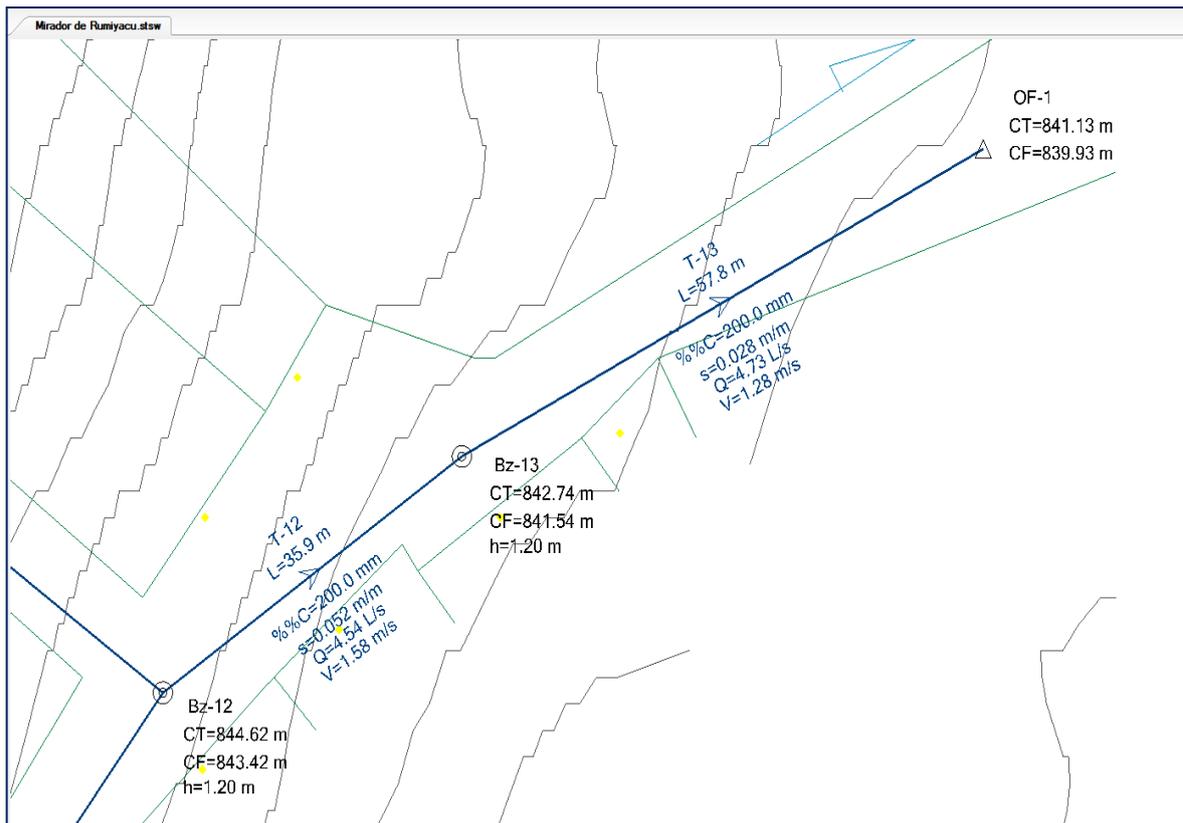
Vista de planta del buzón 12 al punto de descarga OF-1. (Fuente: Software SEWERCAD).
